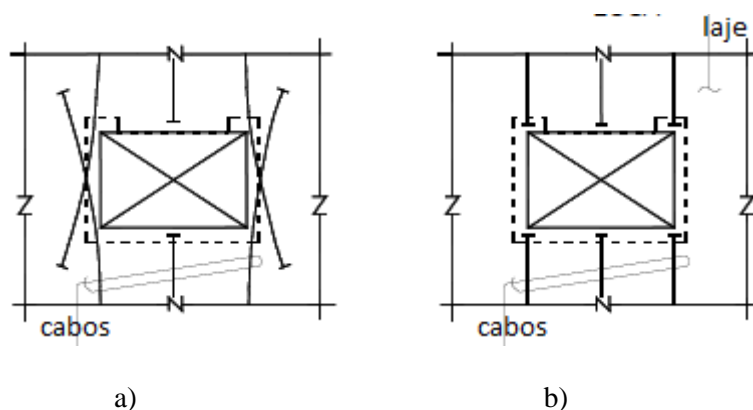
Traçado dos cabos em planta na zona de aberturas [2] e [16].
